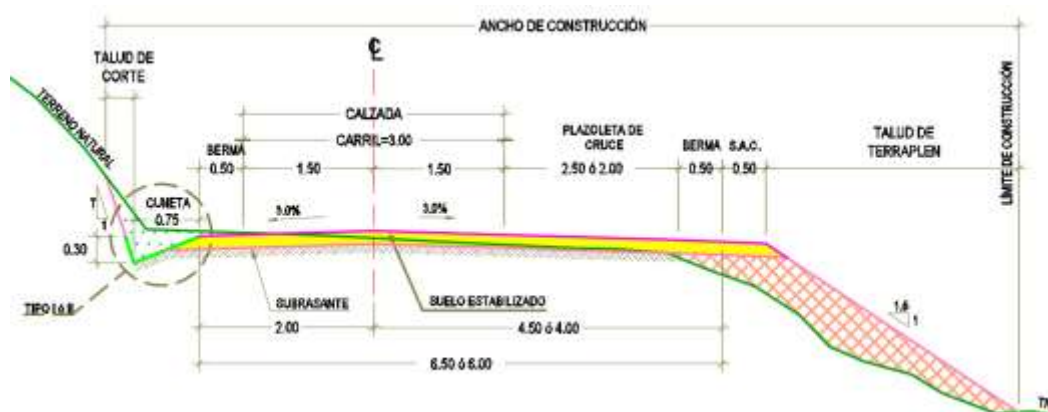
Sección típica con plazoleta de cruce lado derecho. Fuente: Plano de Secciones Típicas.
